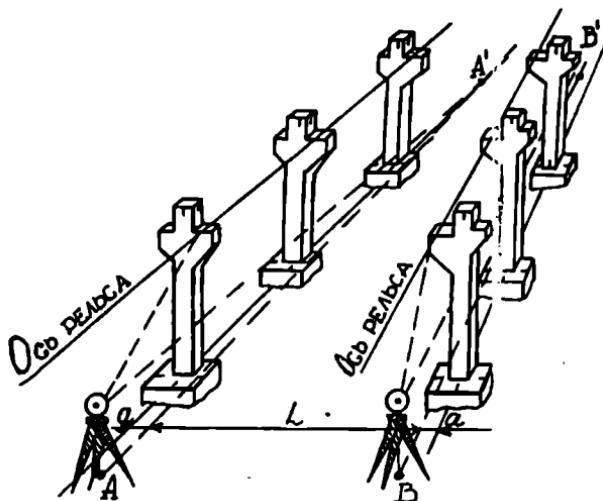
Схема разбивочных работ при монтаже подкрановых путей
